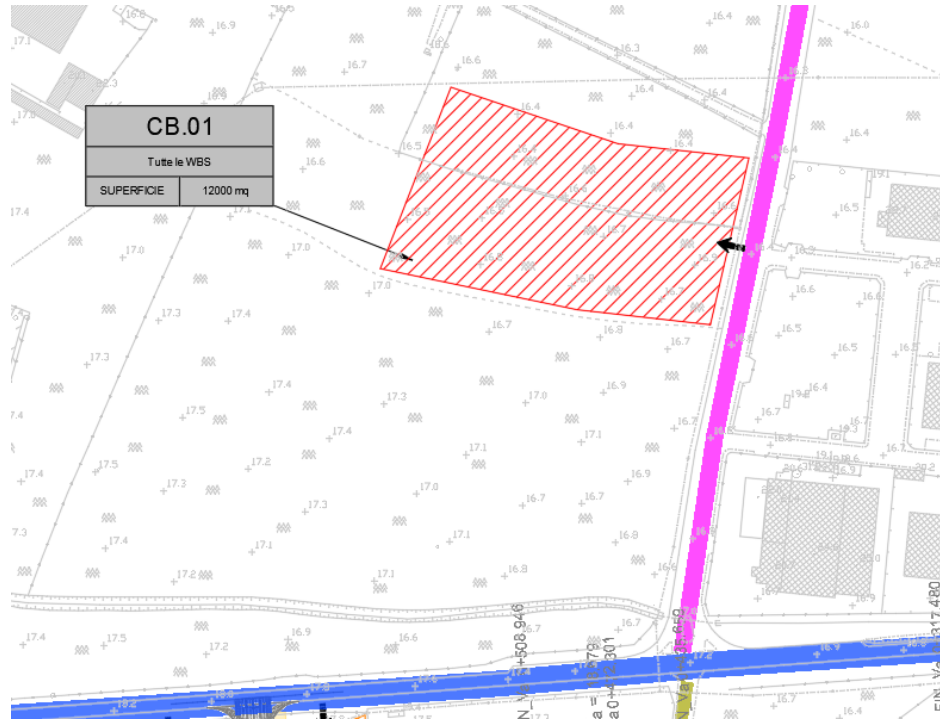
Vista in pianta dell'area di cantiere CB.01
